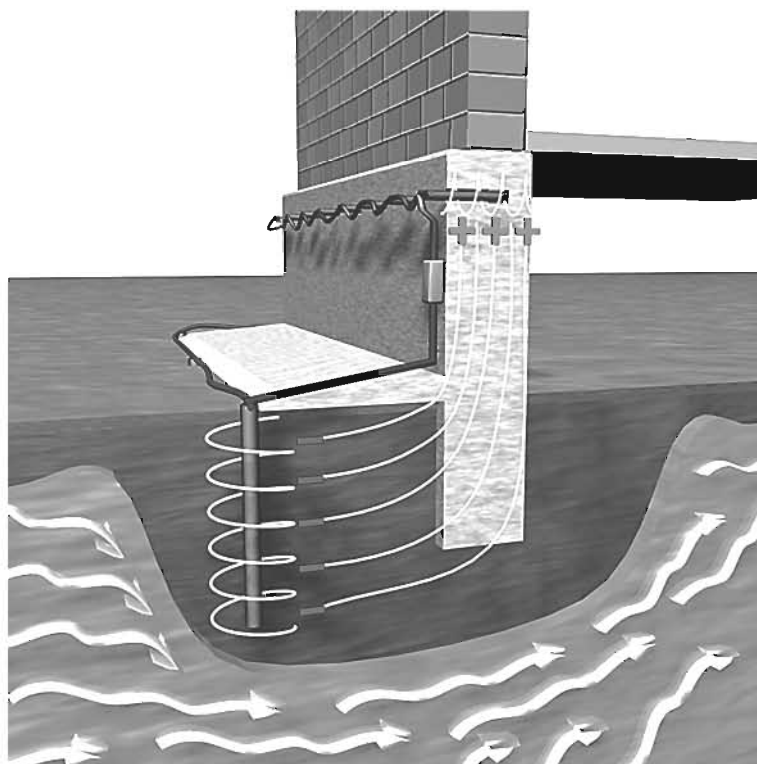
«Гальваноосмос»» — надёжная защита здания от сырости, даже если есть подпор грунтовых вод под фундамент здания.
